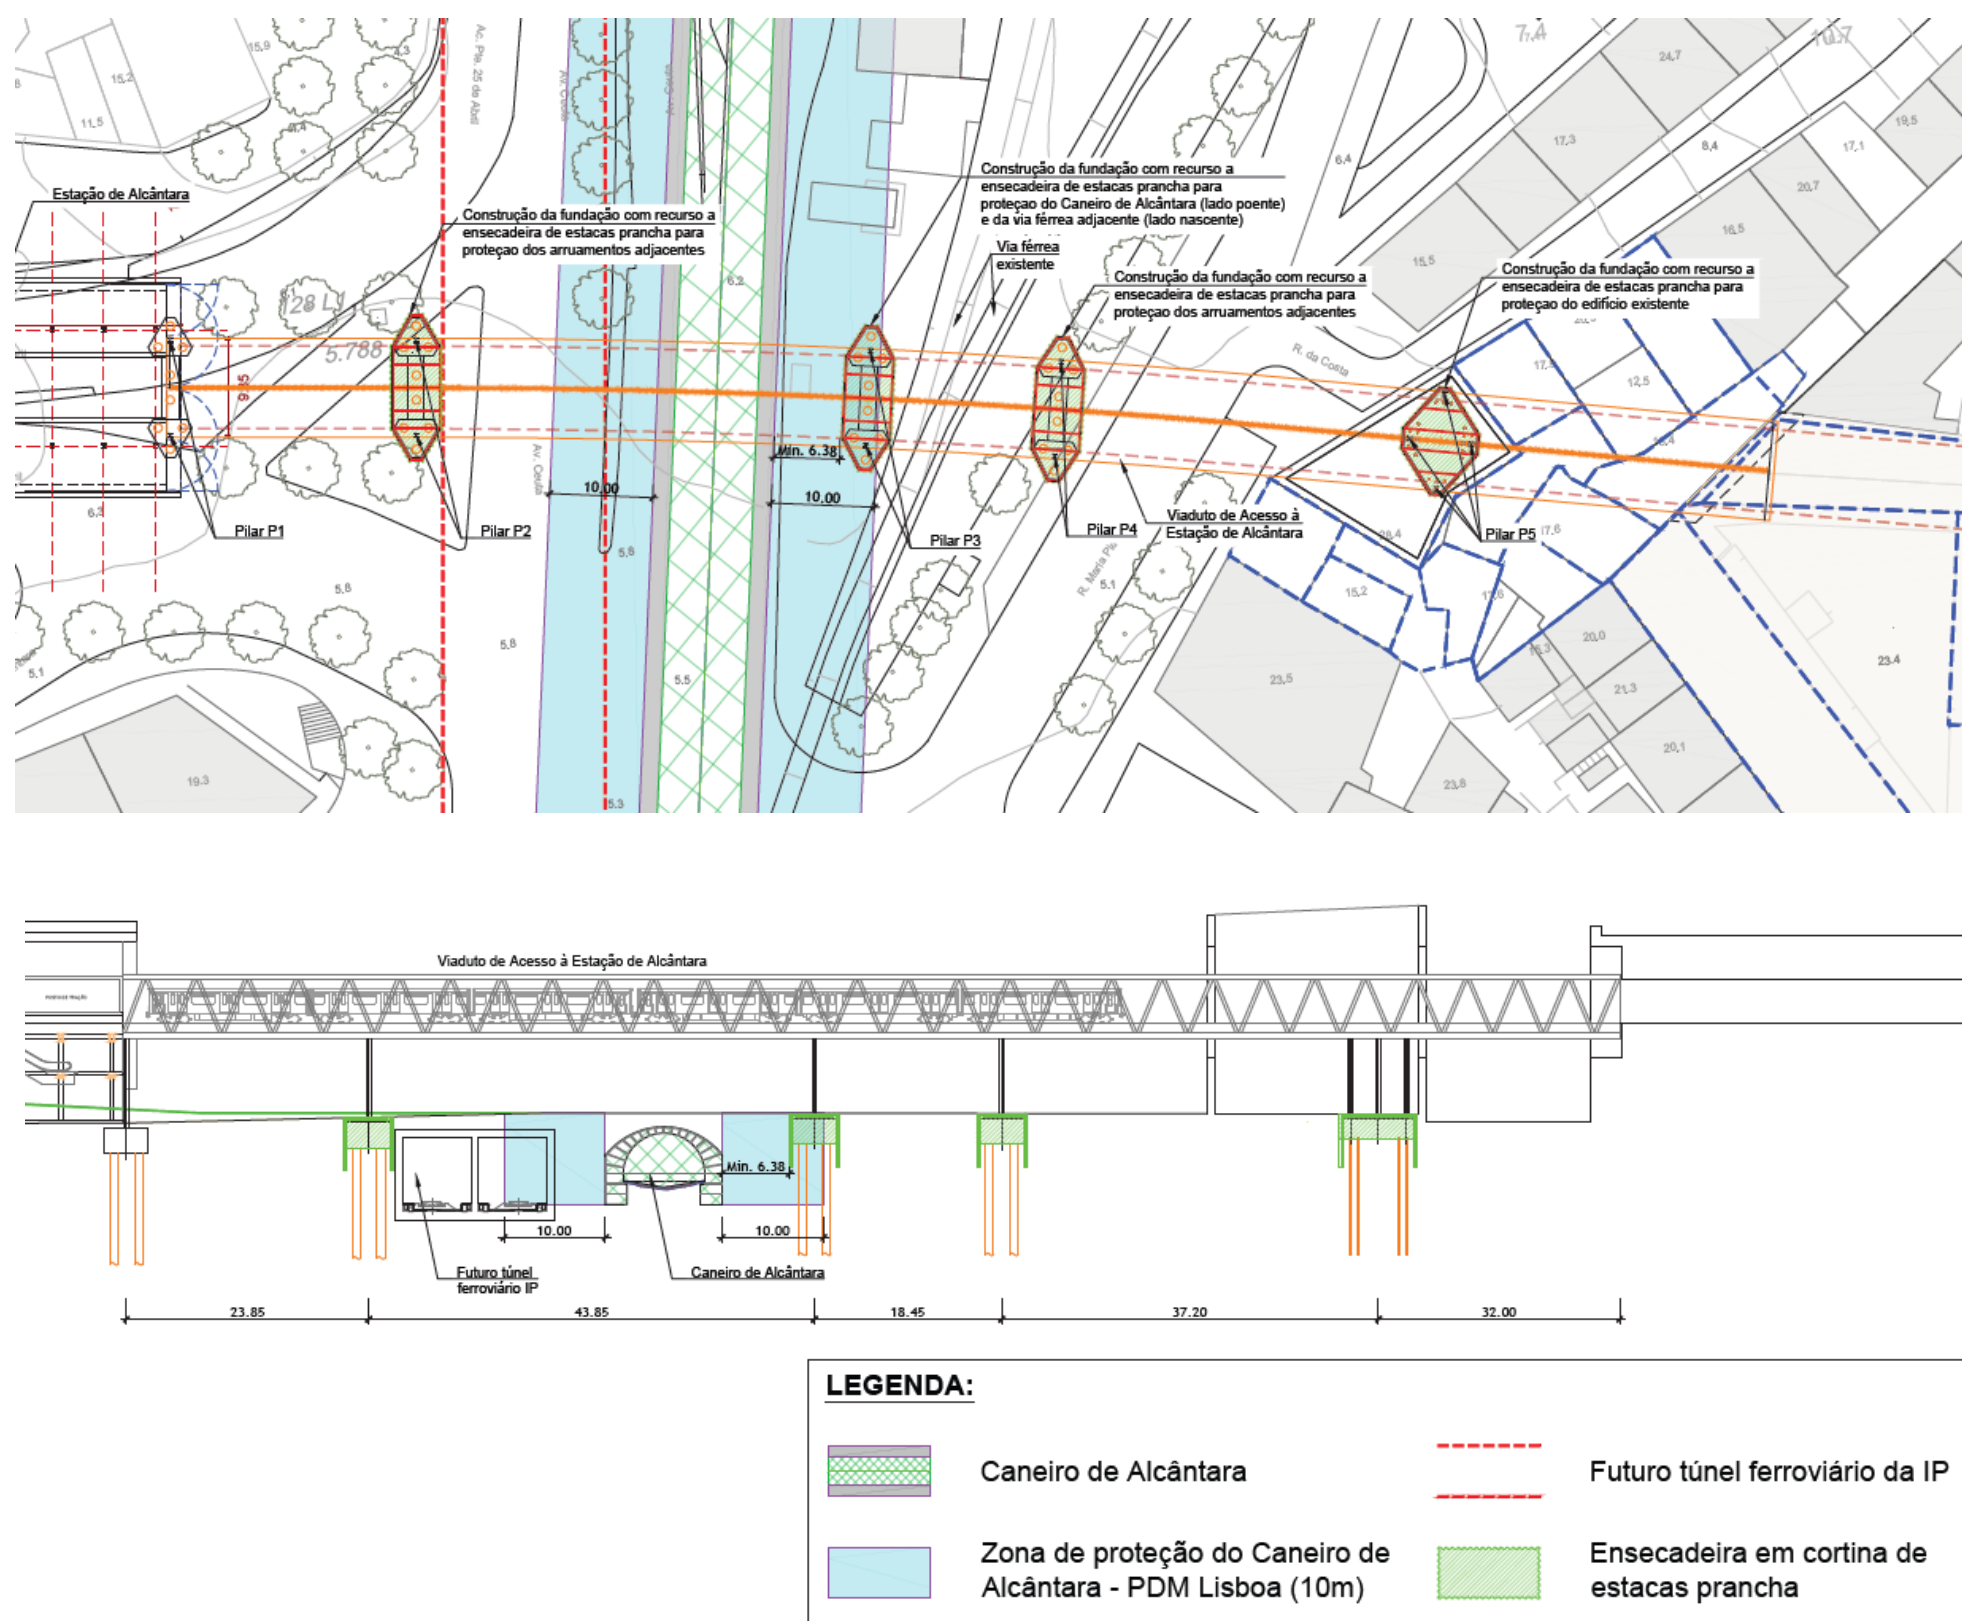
Viaduto de acesso à Estação de Alcântara – planta e perfil longitudinal
